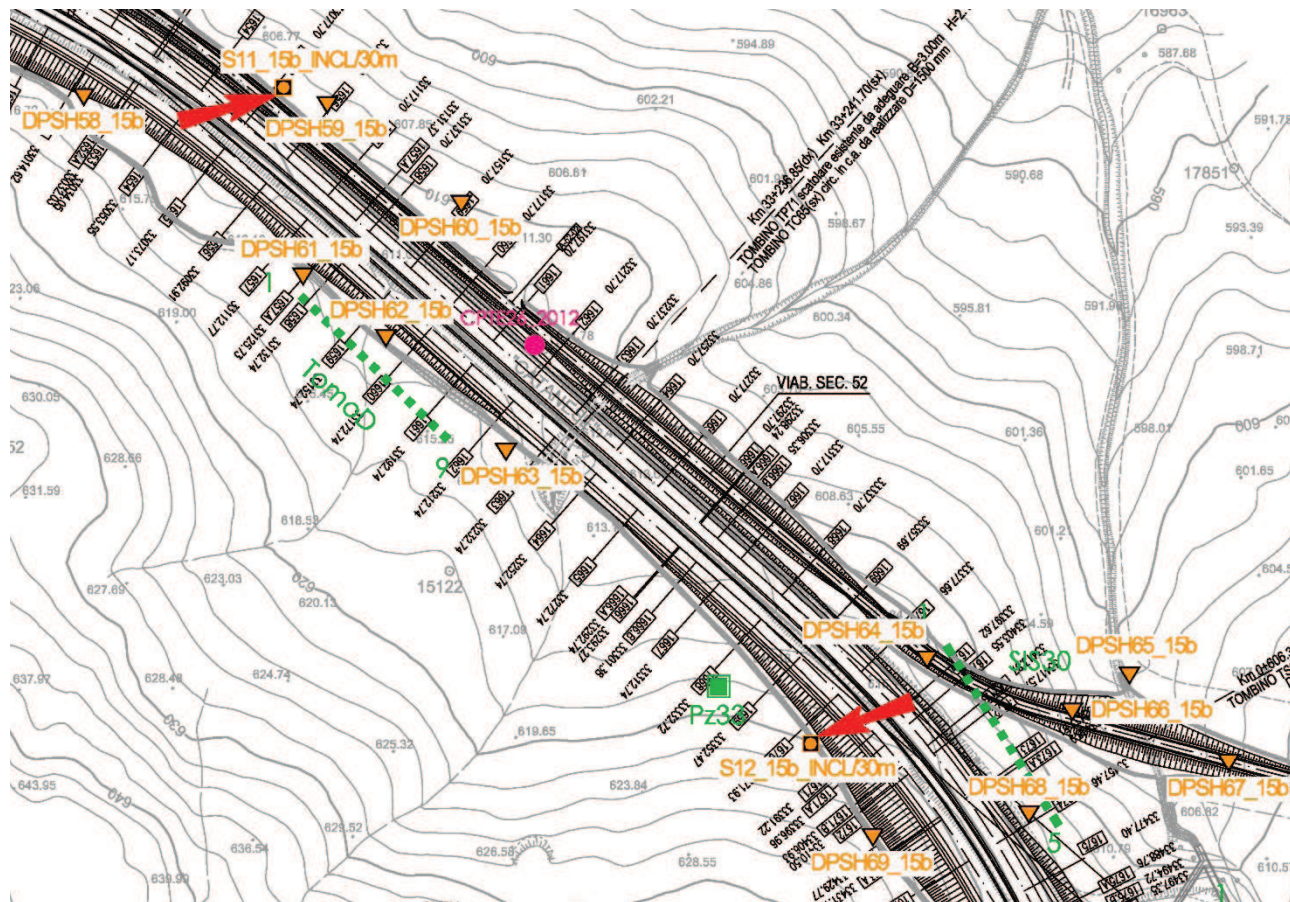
13 PK 33+077. Planimetria ubicazione indagini
